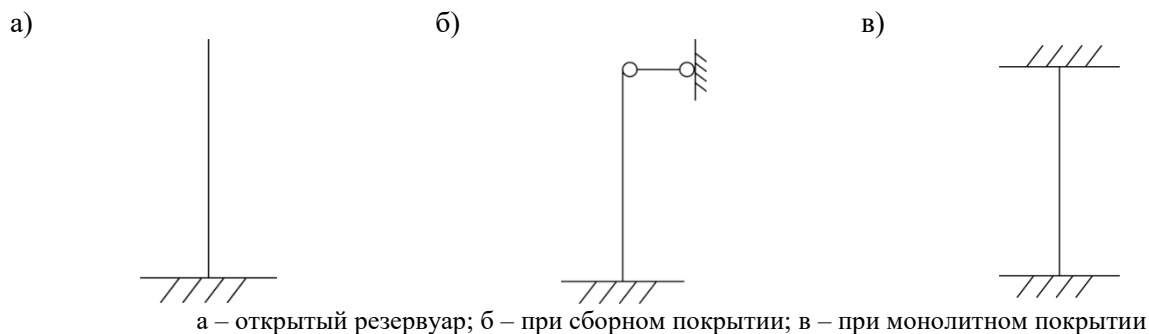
К определению соотношения сторон стен резервуара
